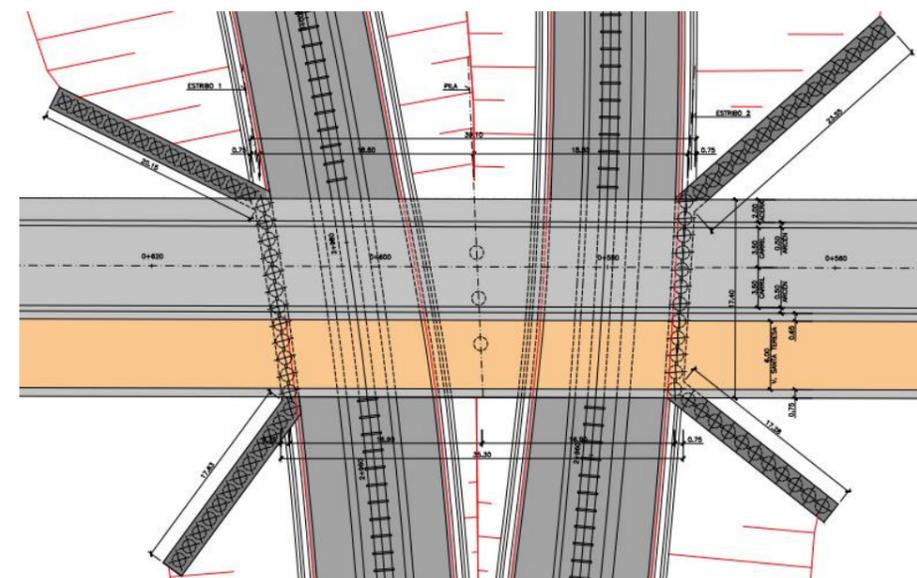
PLANTA Y ALZADO DEL PASO SUPERIOR P.K. 2+990
